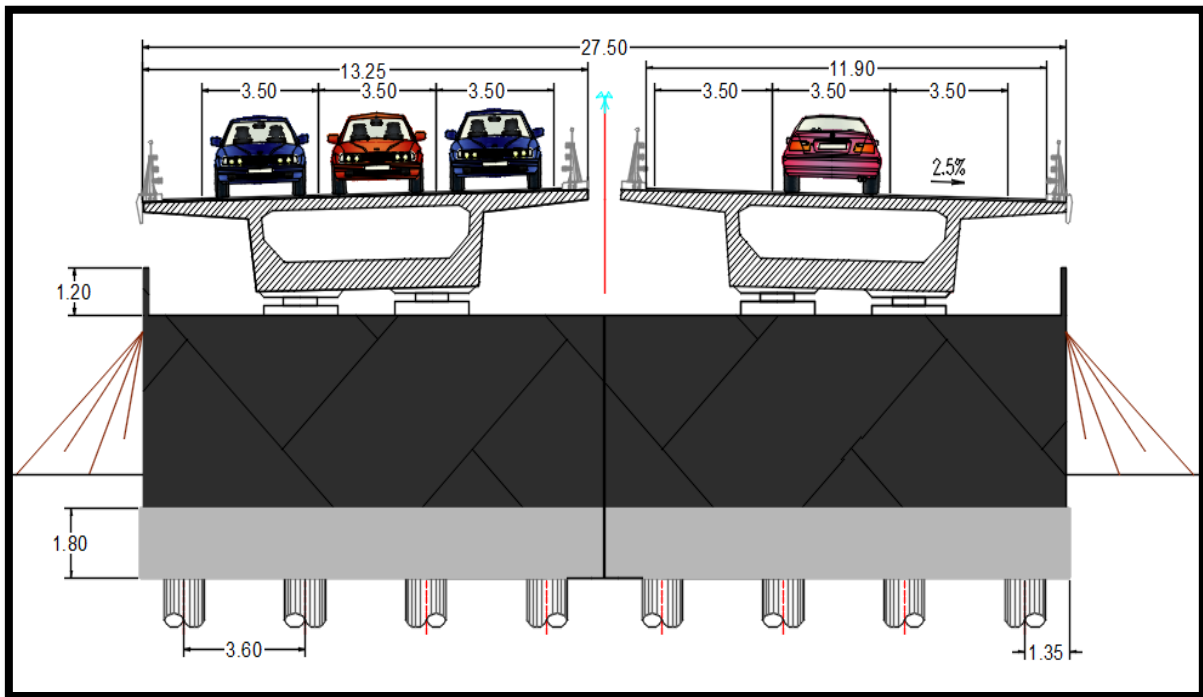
Coupe transversale sur culée VARIANTE 02
